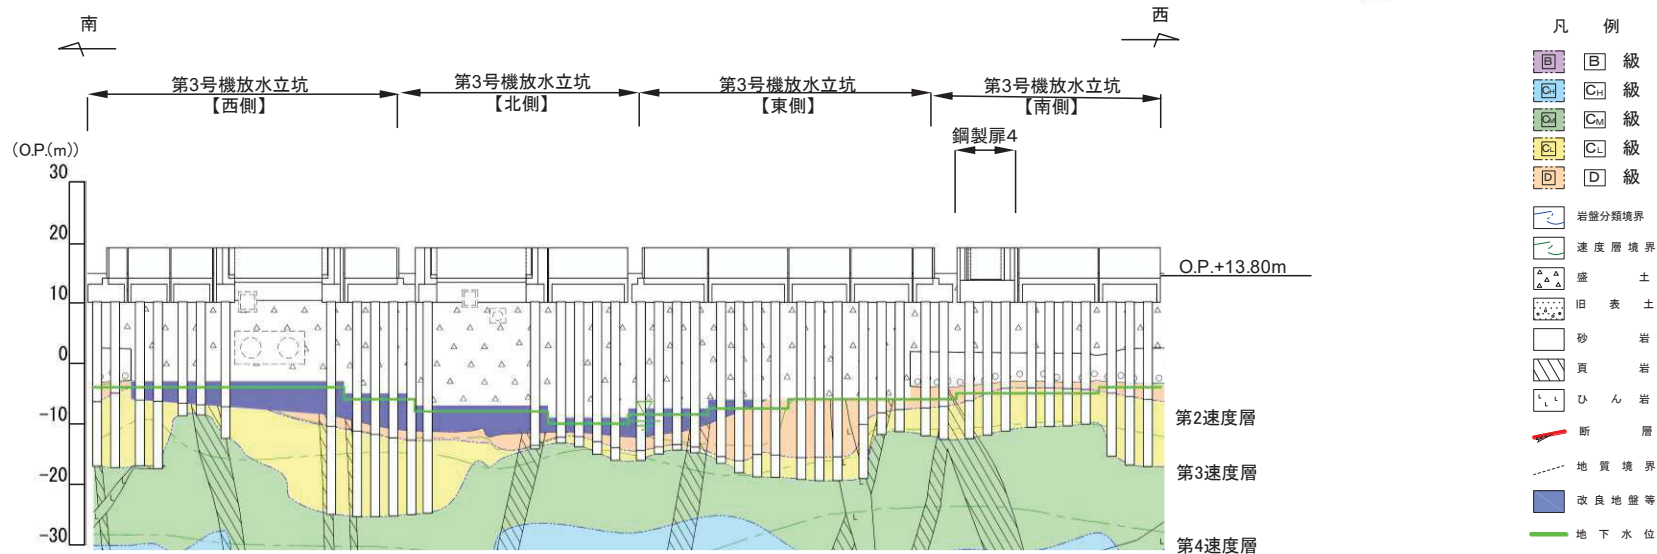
(4) 鋼製扉周辺の地質状況 (第3号機放水立坑)
